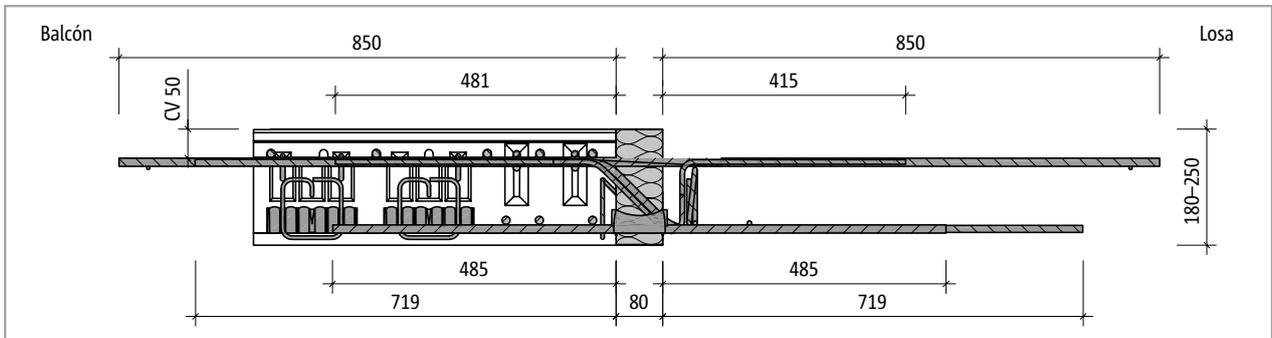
Schöck Isokorb® T tipo C-M2: Sección del producto
